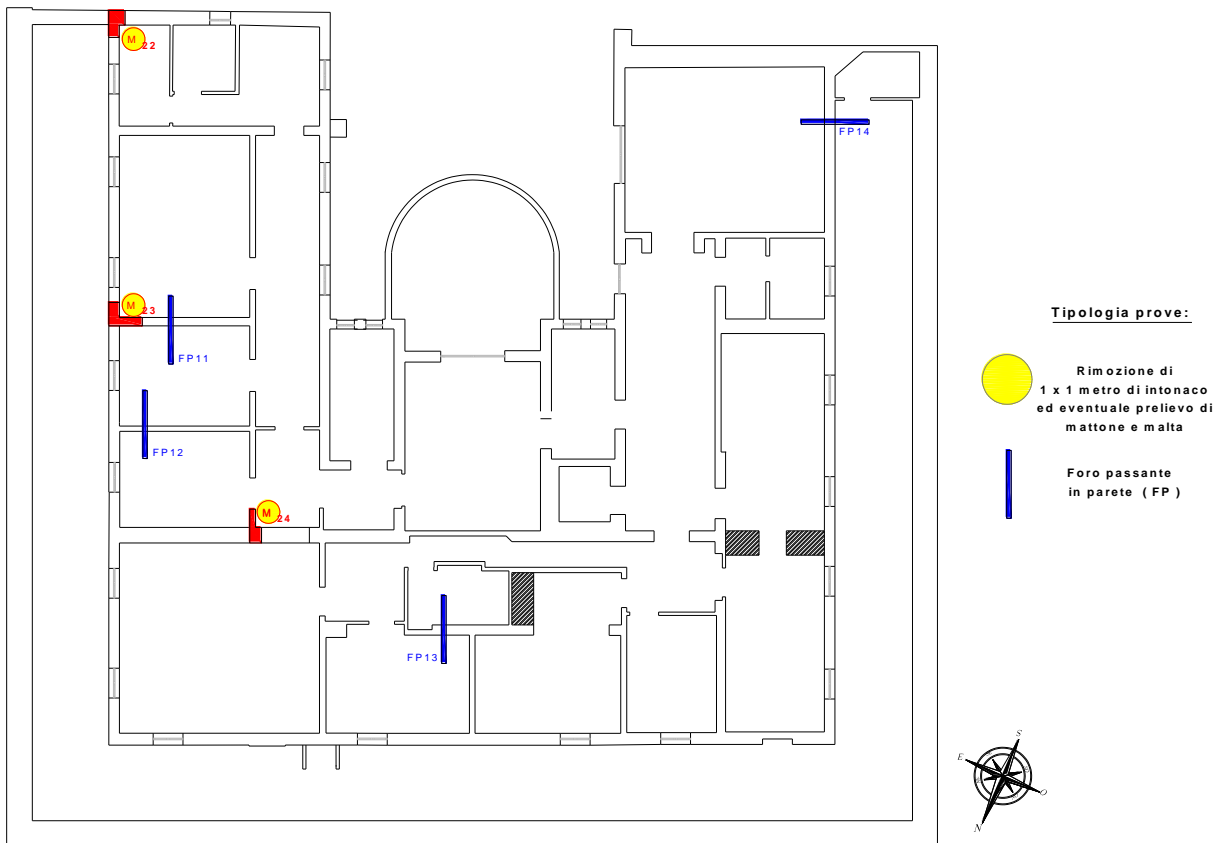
Pianta chiave con indicazione dei punti di sondaggio ai piani secondo e terzo.
